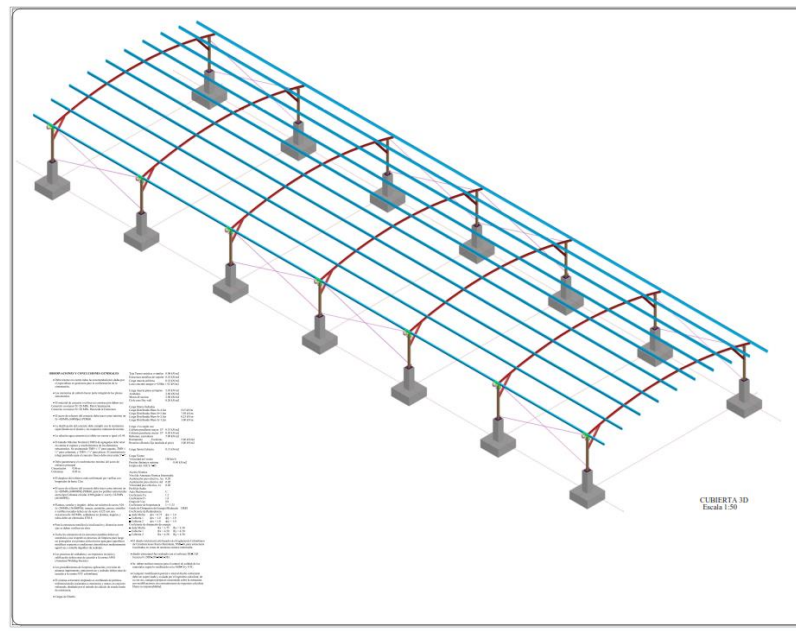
Distribución de zapatas Cancha Escuela Pita y Chone. Fuente: Planos proyecto
